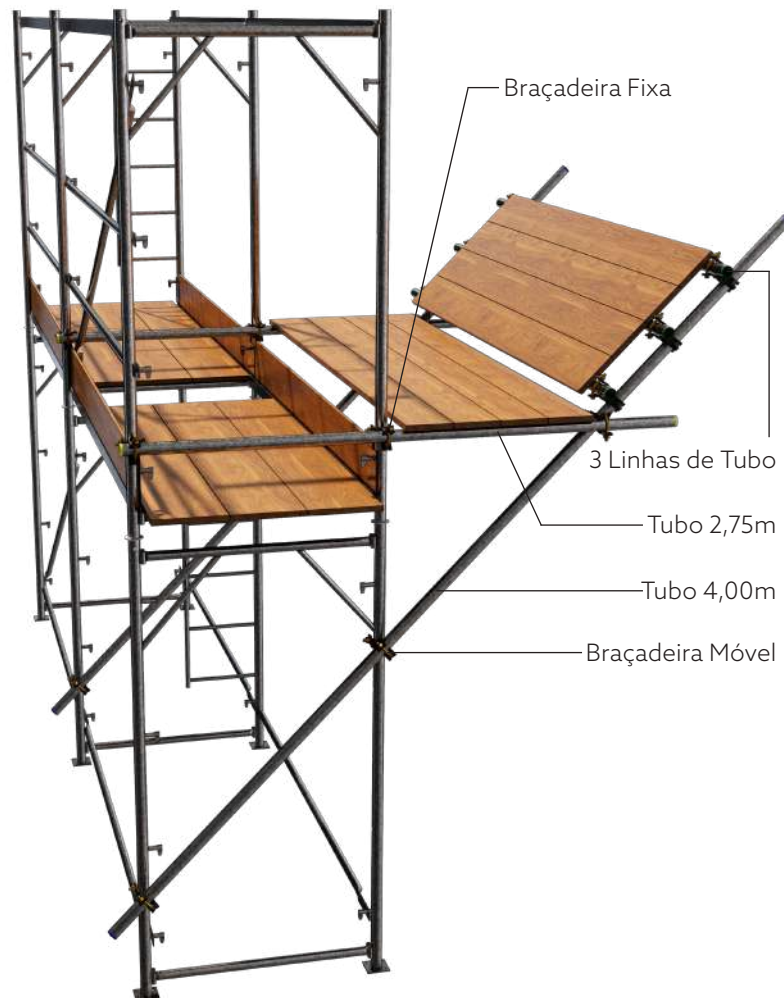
Aparalixo para andaime Fachadeiro® SH
